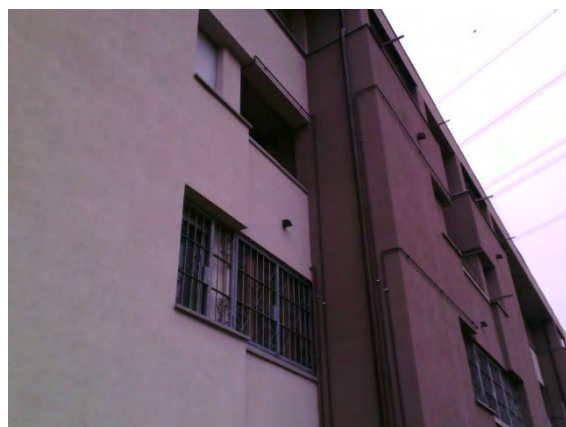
CA\_6: condizione di rilevazione passiva, fascia oraria 9-10. Prospetto sud.
